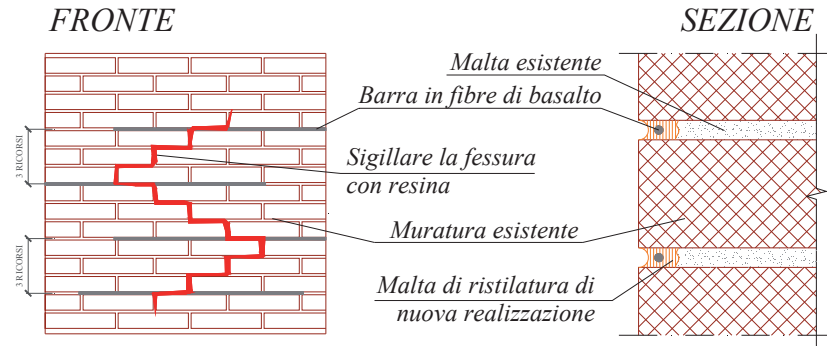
Schema dell'intervento di repointing armato con barre in fibra di basalto sulle murature del campanile.
